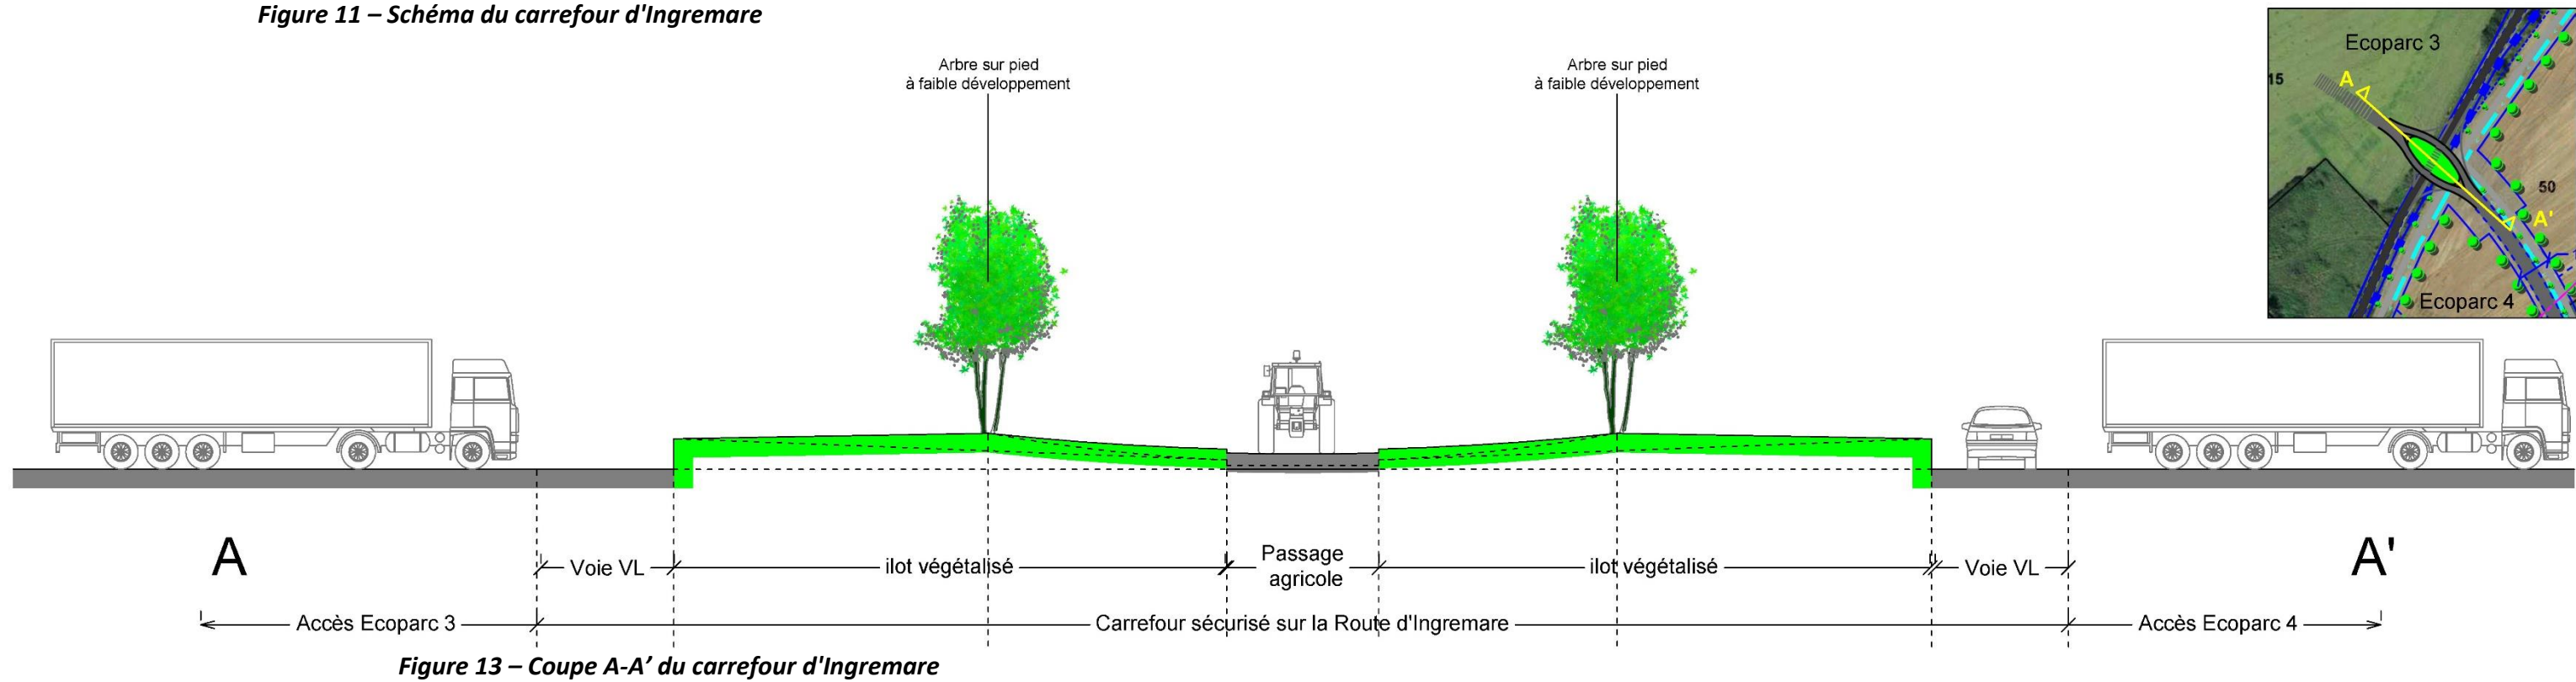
Coupe A-A' du carrefour d'Ingremares
